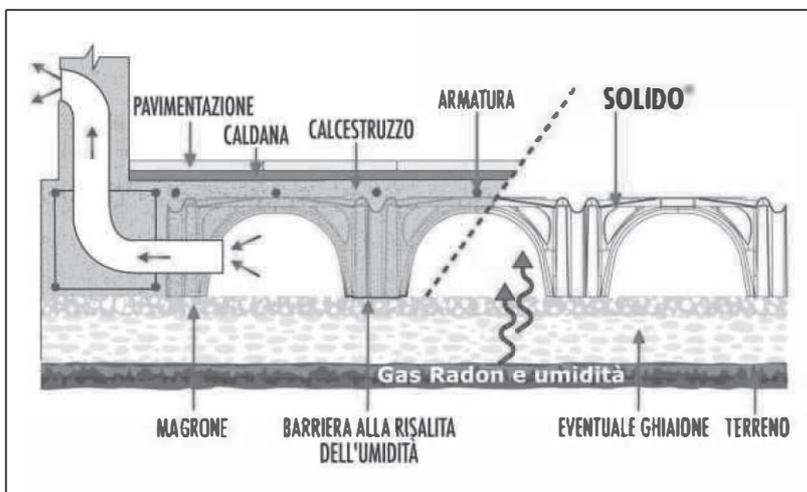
vespaio aerato per l'isolamento del pavimento dall'umidità e dal radon
